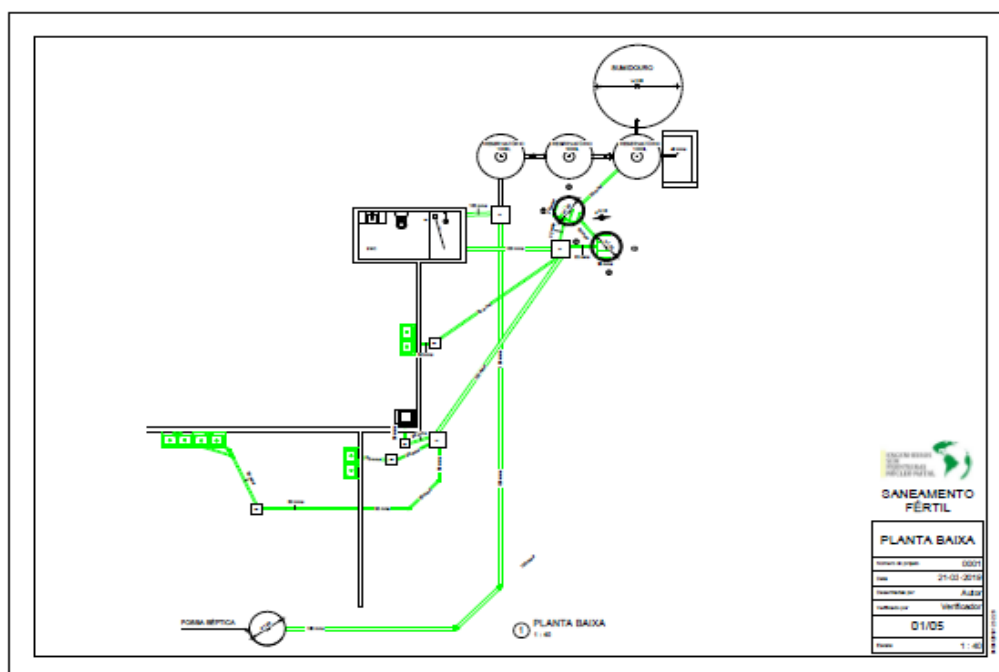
Prancha do projeto integrado do sistema de tratamento de esgoto - Planta baixa
